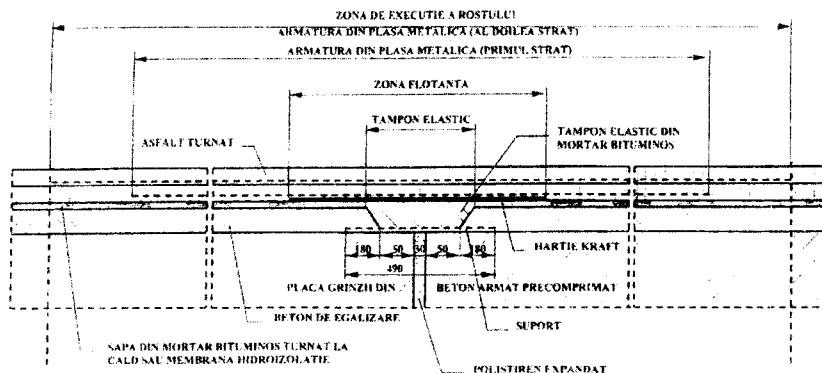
Secțiune longitudinală prin rost din asfalt turnat armat cu plasă de sârmă
